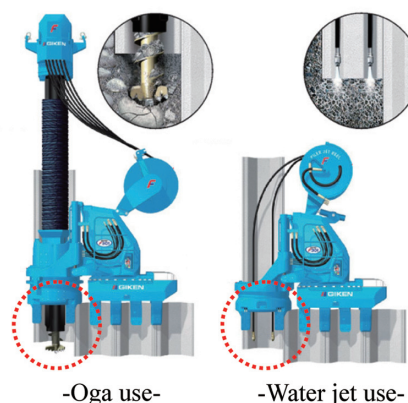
硬質地盤対応時の圧入施工法<sup>2)</sup>
